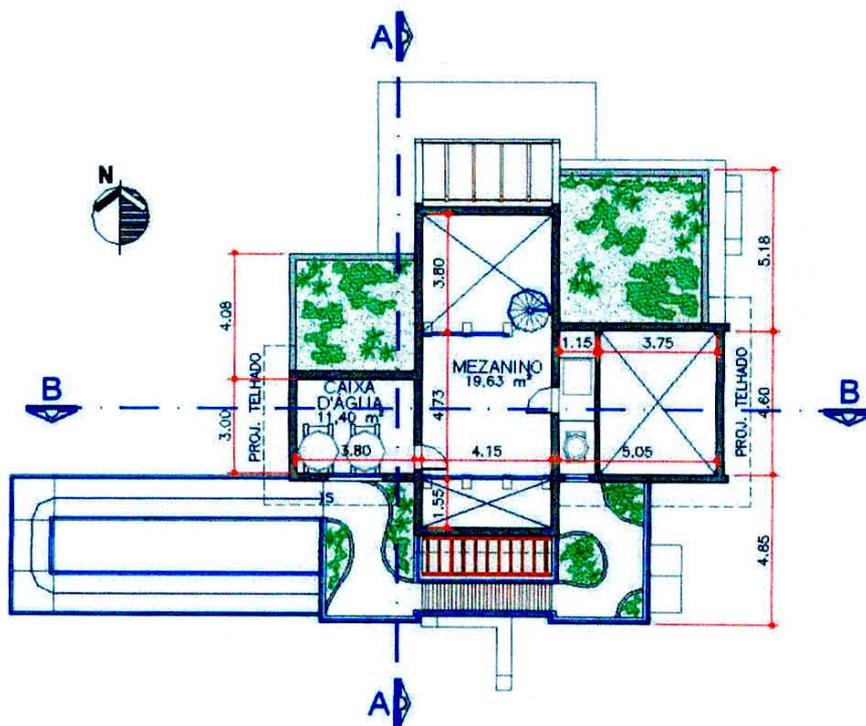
Planta baixa da Casa Eficiente – Mezanino
